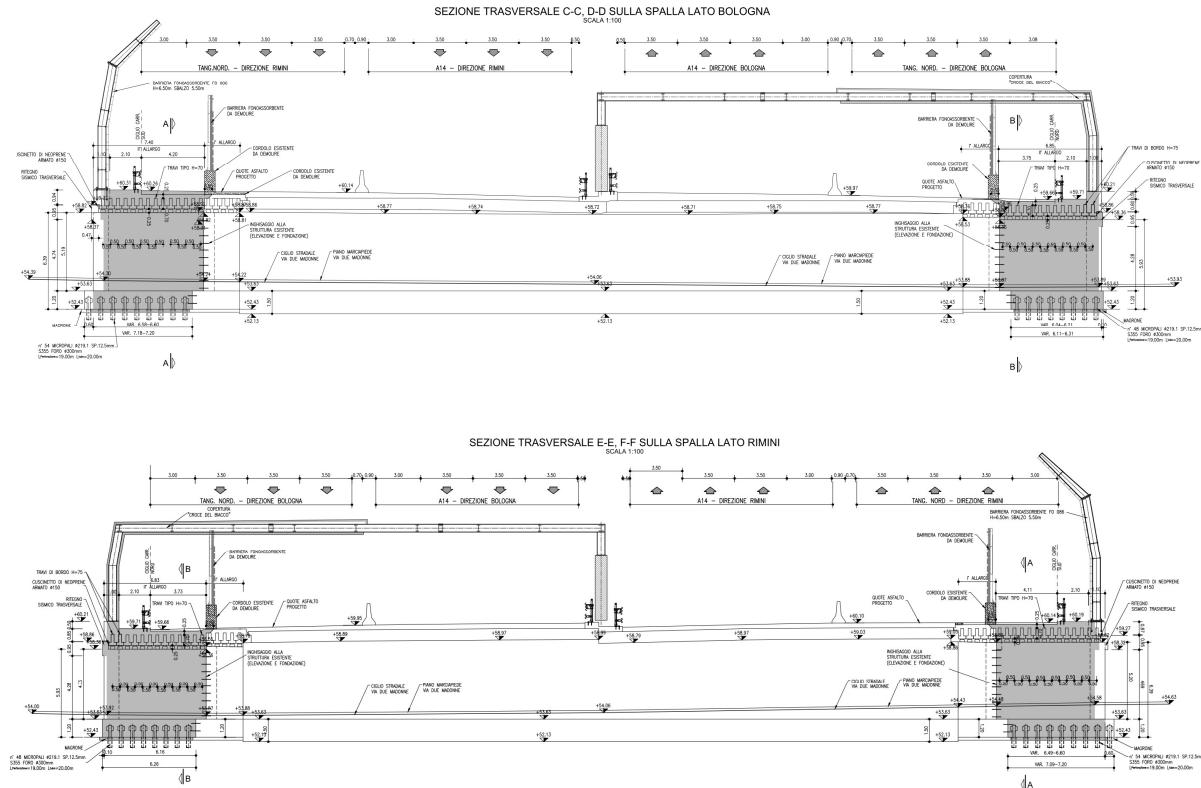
Sezioni trasversali sulle spalle
